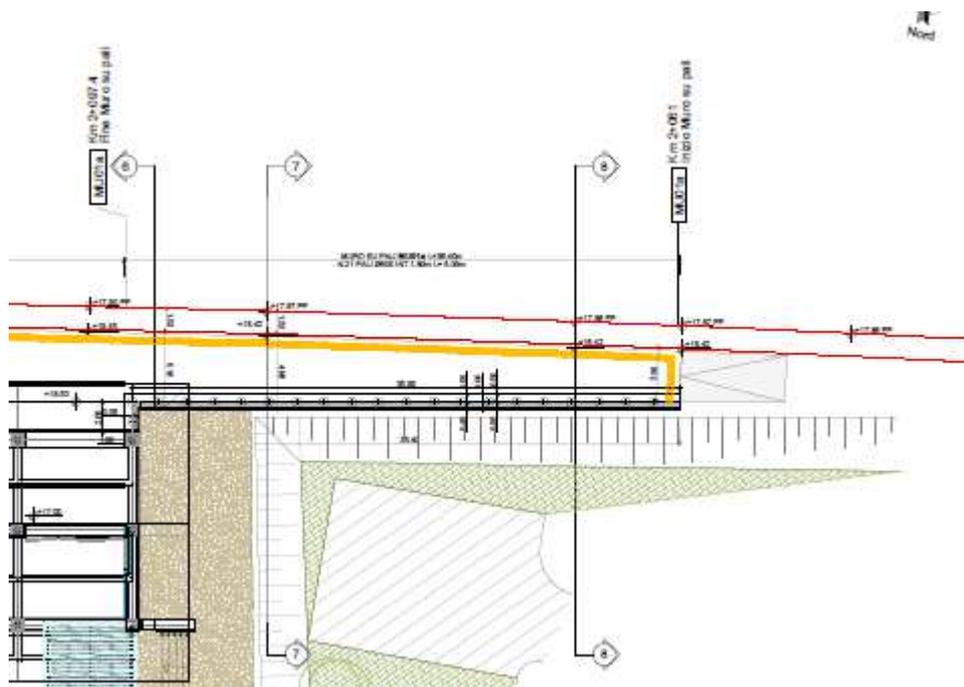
Muro di sostegno su pali – Pianta lato est del fabbricato
